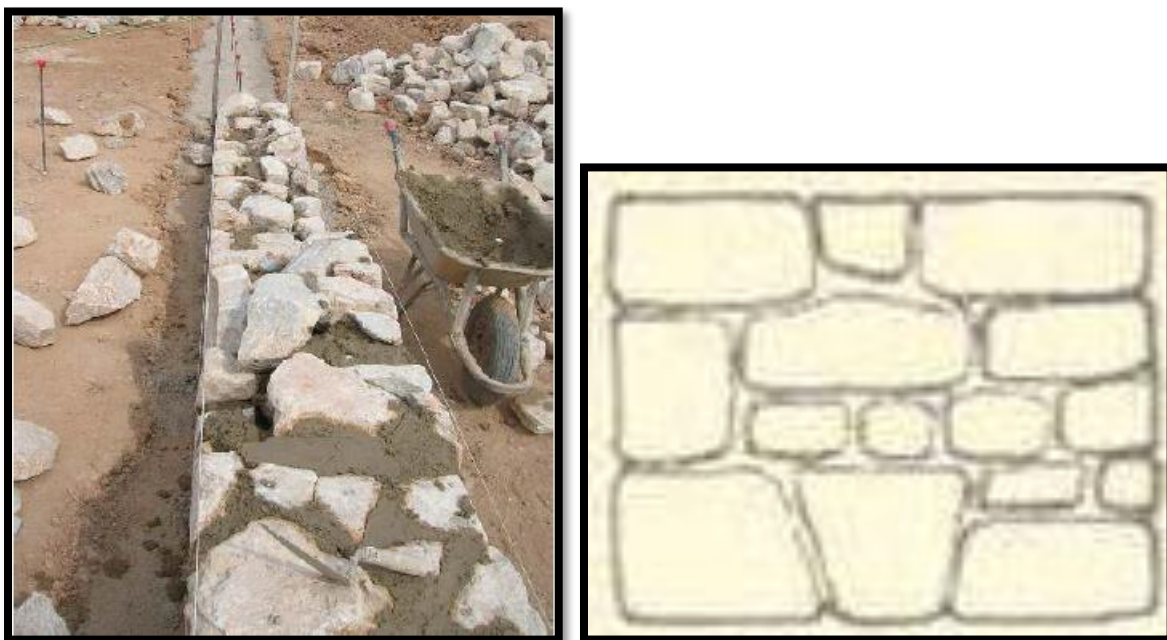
Muro de piedra. Fuente: www.scribd.com/doc/manual-de-construccion-apasco-pdf
